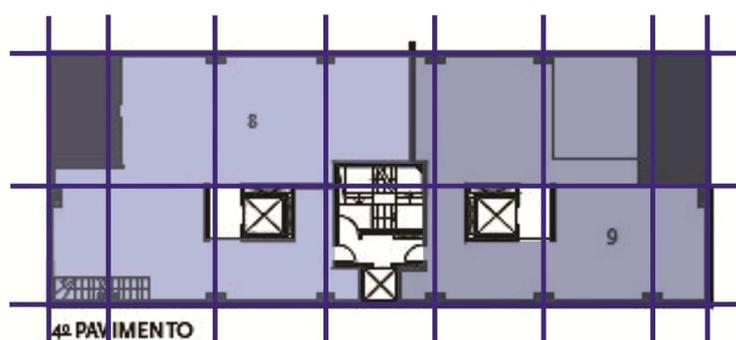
Edifício Ourânia. Planta baixa com esquema de modulação estrutural.
